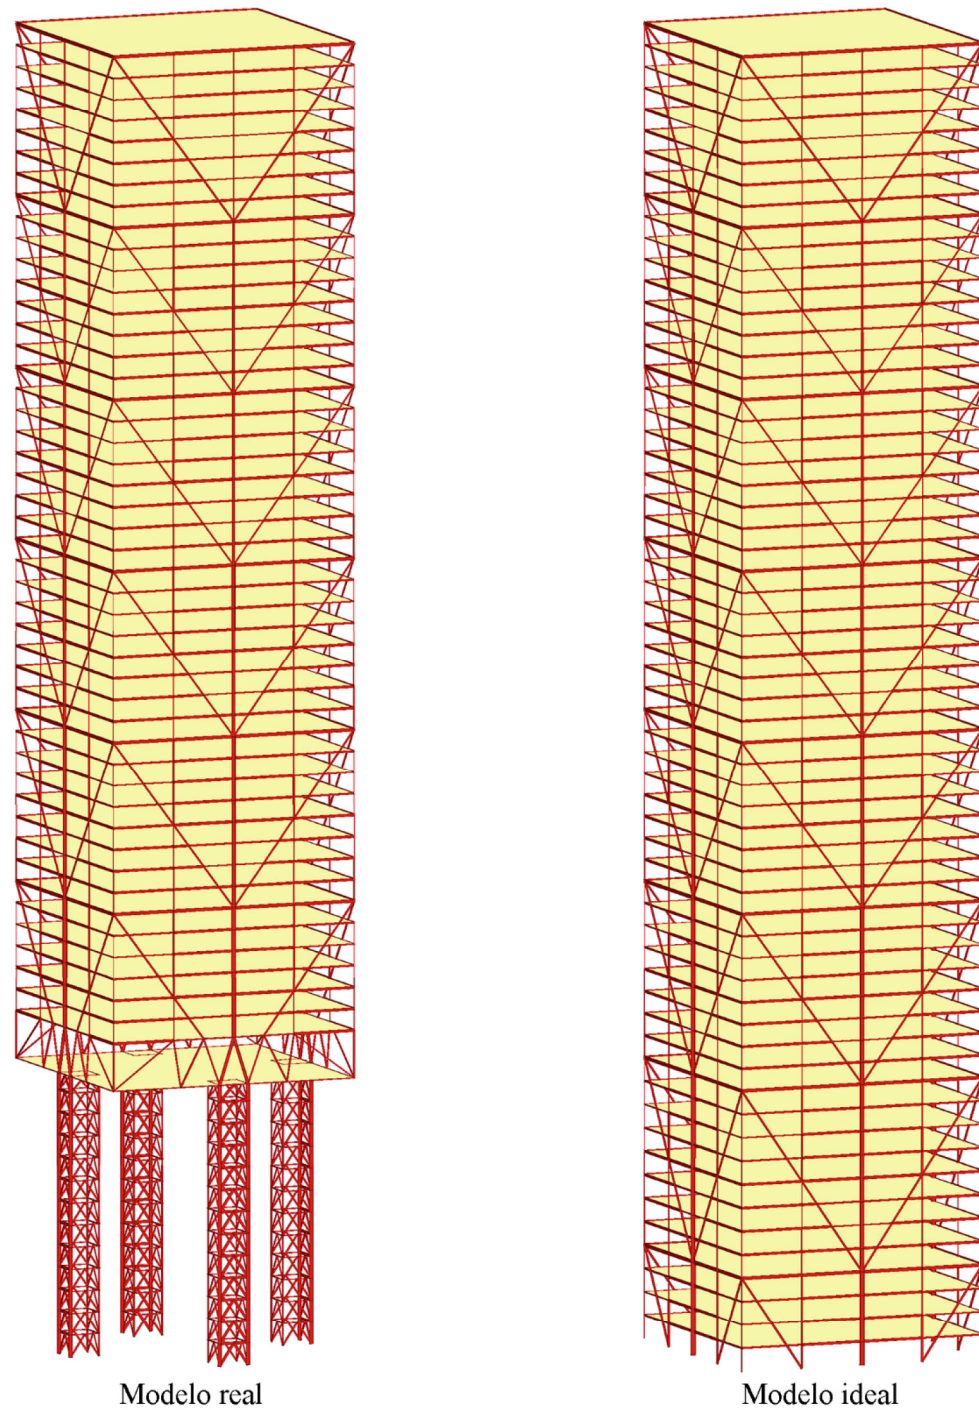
Modelos tridimensionales elaborados para recalculer las cargas de viento aplicadas a los alzados aislados.
